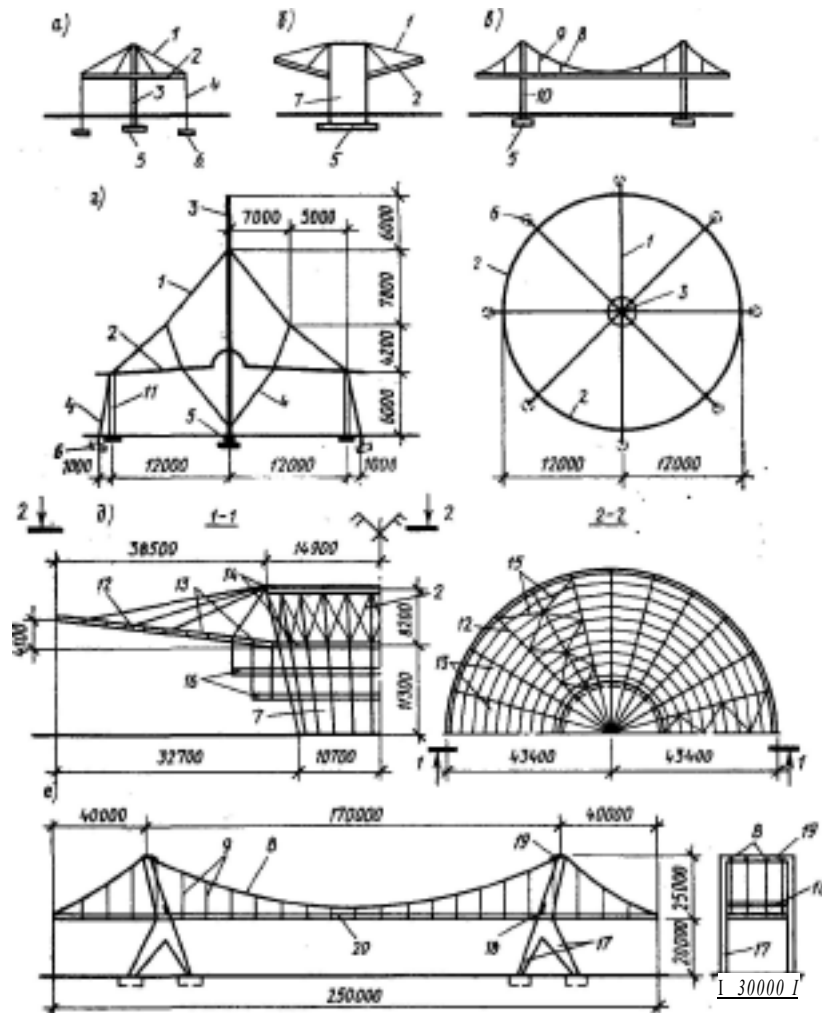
Подвешенные на вантах жесткие покрытия:
